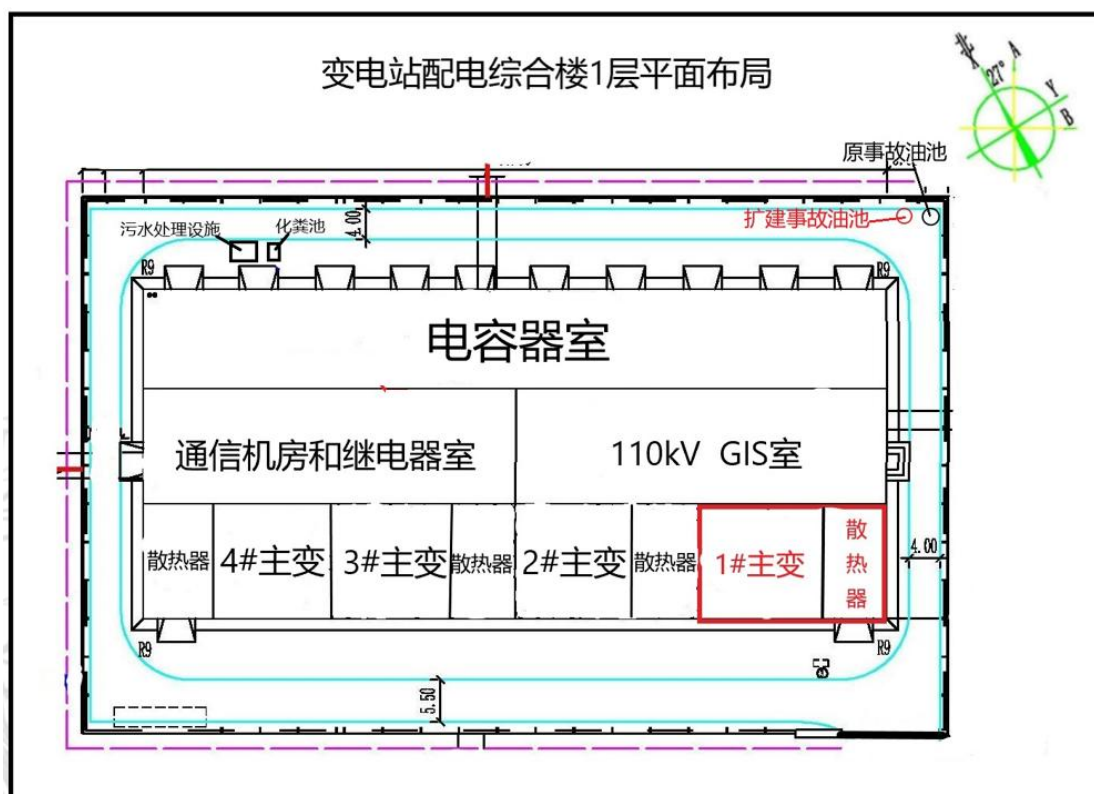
玄武 330kV 变电站站区平面布置示意图（1层）
